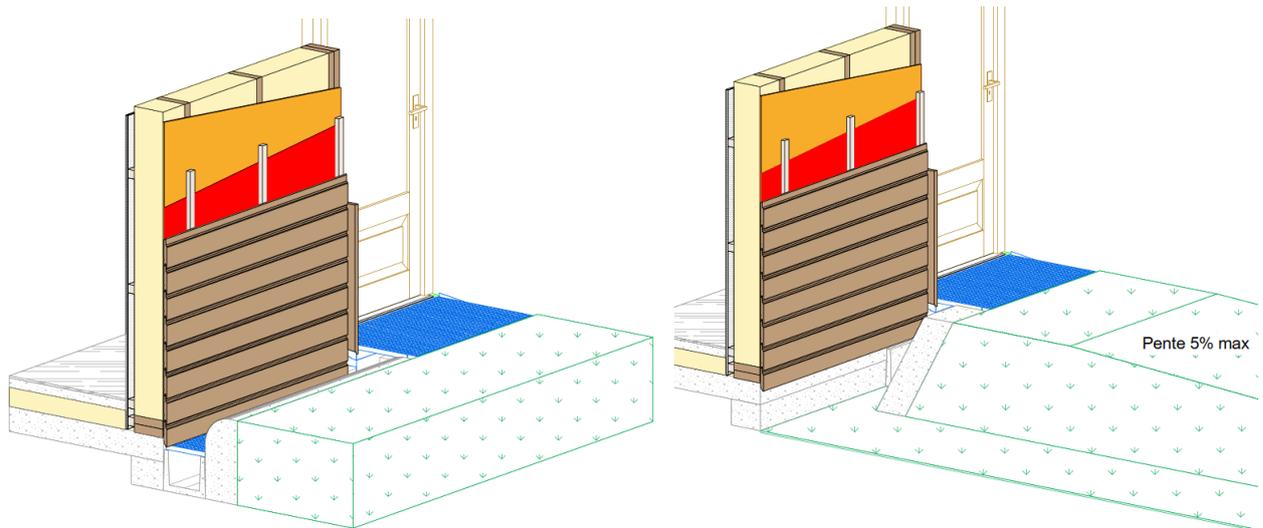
Exemple de gestion de seuil PMR par la mise en place d'un caniveau : caniveau filant (à gauche) ou caniveau ponctuel avec rampe d'accès (à droite)
